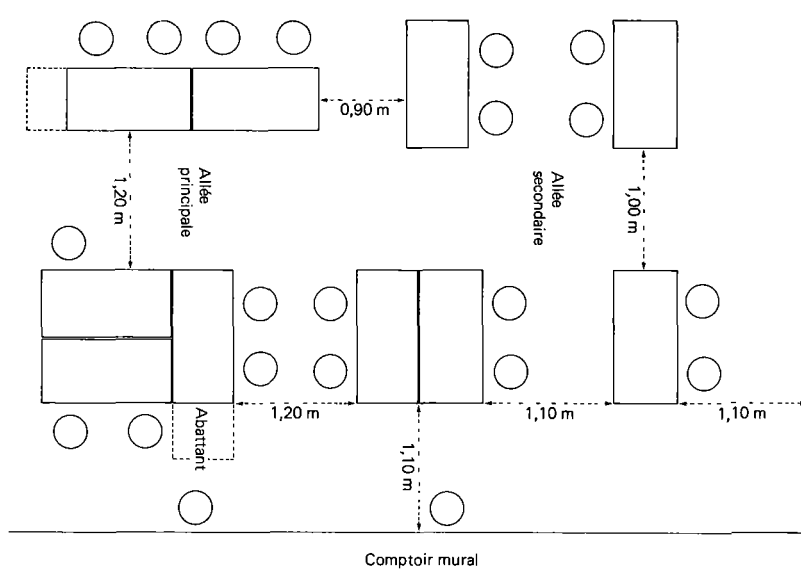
Modèle de disposition des plans de travail. Il n'est pas indispensable que les tables des élèves soient rectangulaires; les formes hexagonales ou trapézoïdales donnent de la souplesse et facilitent le travail en groupe. La hauteur des plans de travail devrait être d'environ 0,68 m à 0,79 m pour le travail assis, et de 0,76 m à 0,91 m pour le travail debout. Vérifier les données anthropométriques locales.
